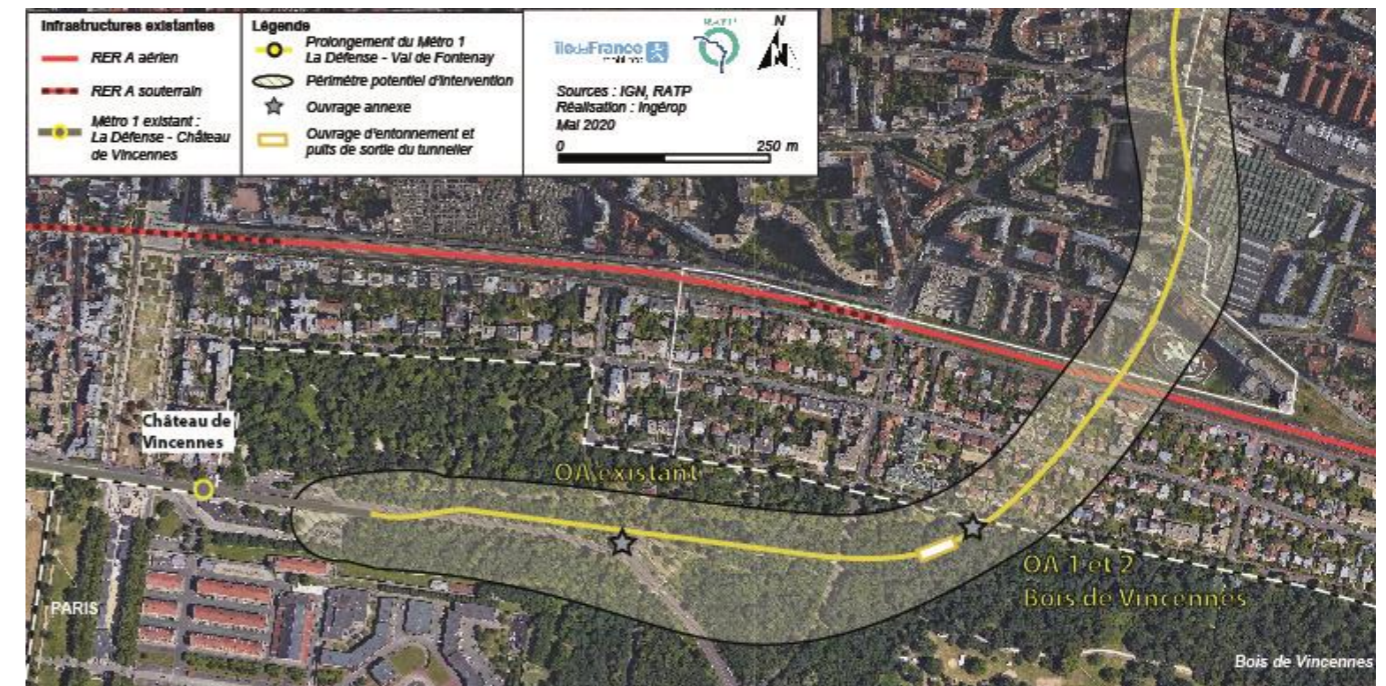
Extrait du PGT – Zoom sur le raccordement à l'existant (Source : Ingérop)
